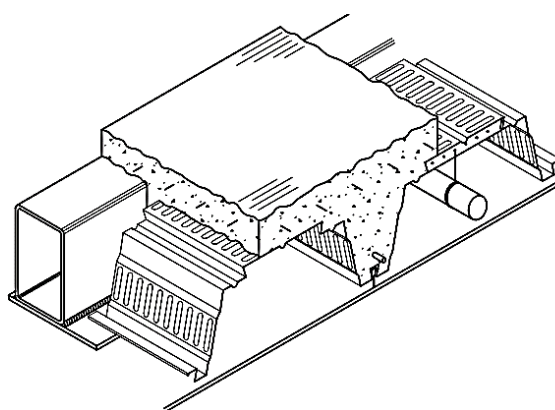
Tipologia de viga *RHS Slimfloor edge beams* (Mullett, 1997).
